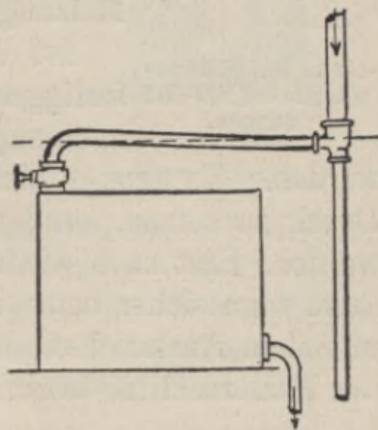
Luftsack an einem Warmwasserheizkörper.
